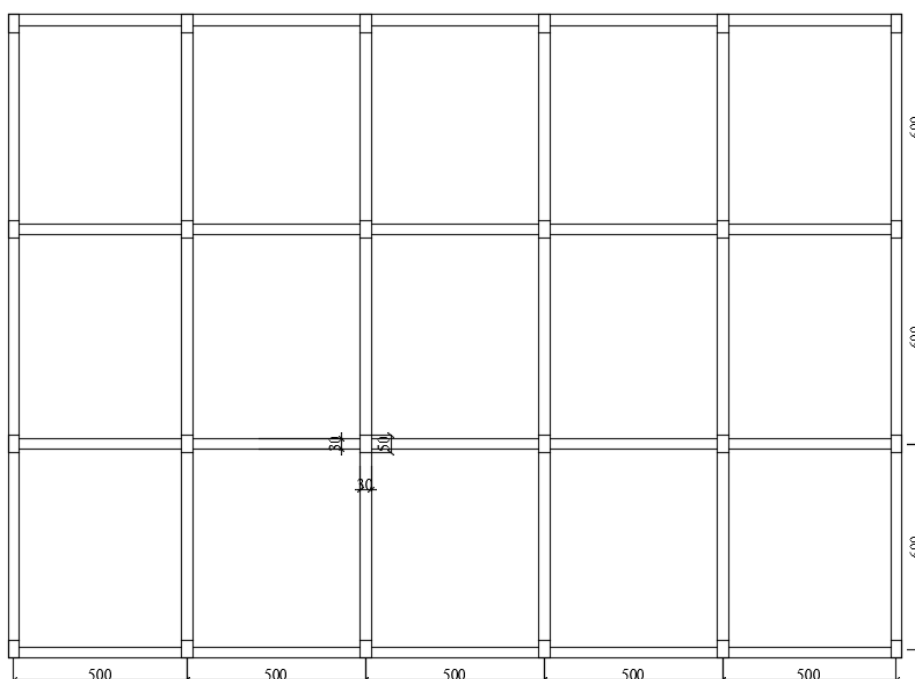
Nomenclatura utilizada para pilares, vigas e lajes.
